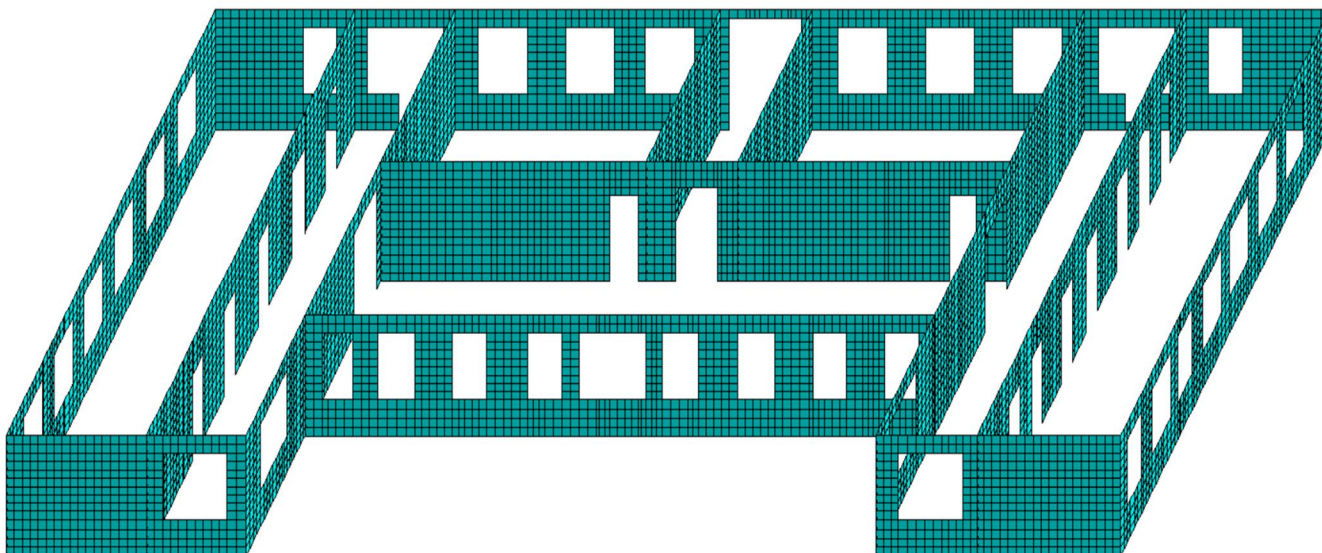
Розрахункова схема несучих конструкцій другого поверху будівлі.
